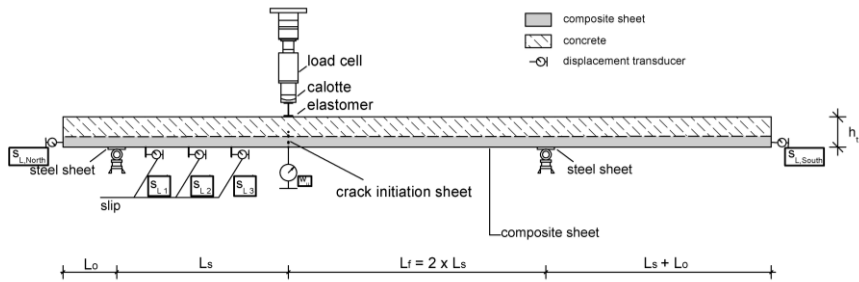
Versuchsaufbau der Drei-Punkt-Biegekörper mit der Bezeichnung V_{LC} 20 bis V_{LC} 23.
